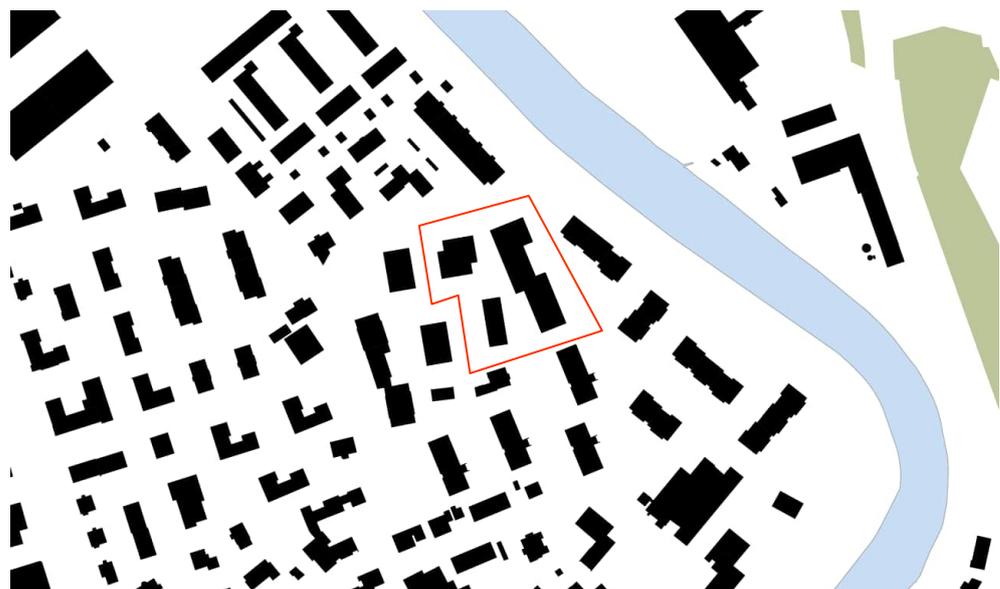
Schwarzplan mit Planungsperimeter (rot)
